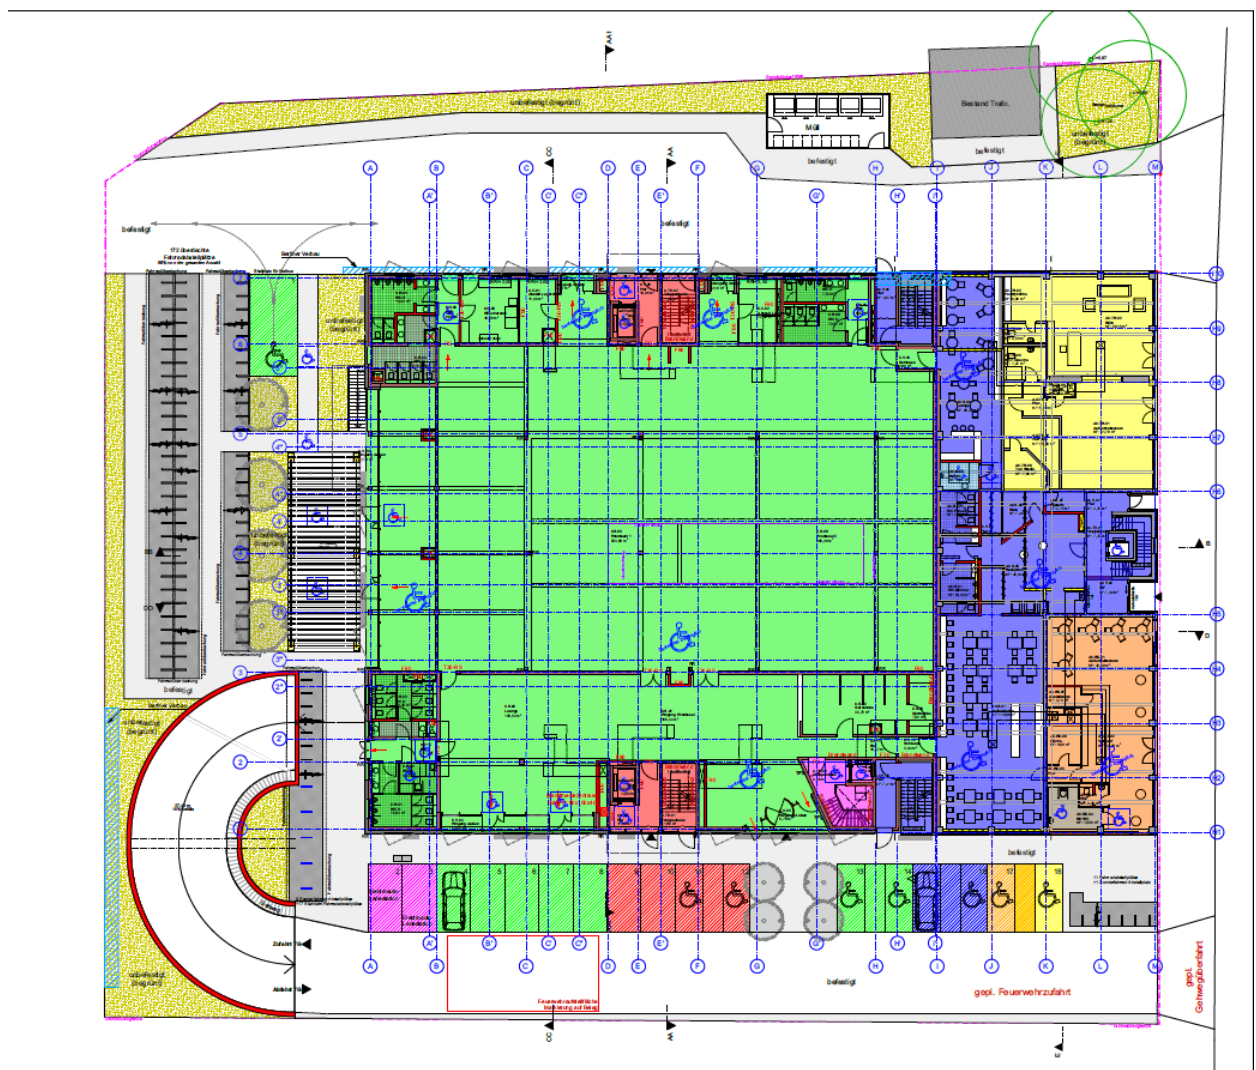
Lageplan mit Nutzungsbereichen Gesamtvorhaben (aus [3])
